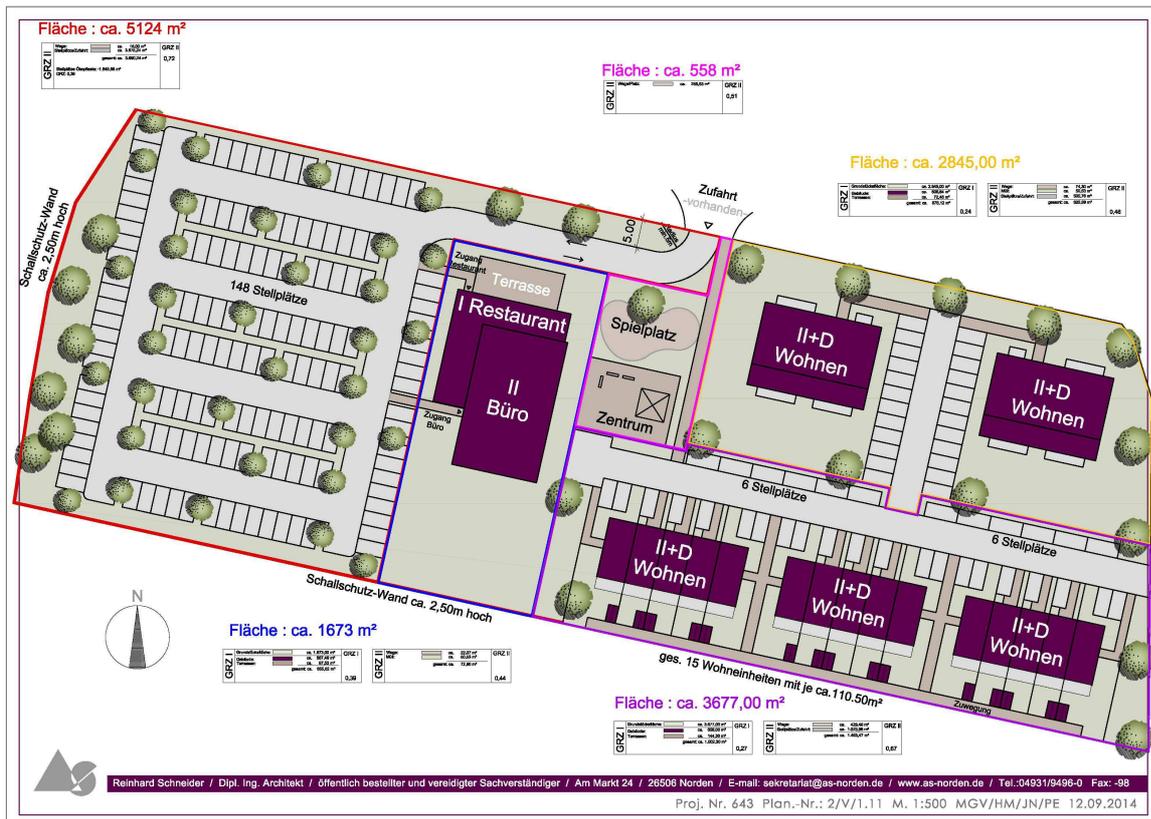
Bebauungskonzept Grünberger Straße (Stand: 9/2014)
